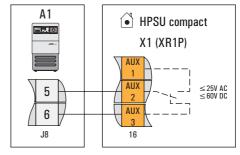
Collegamento contatto di commutazione (uscita AUX)
